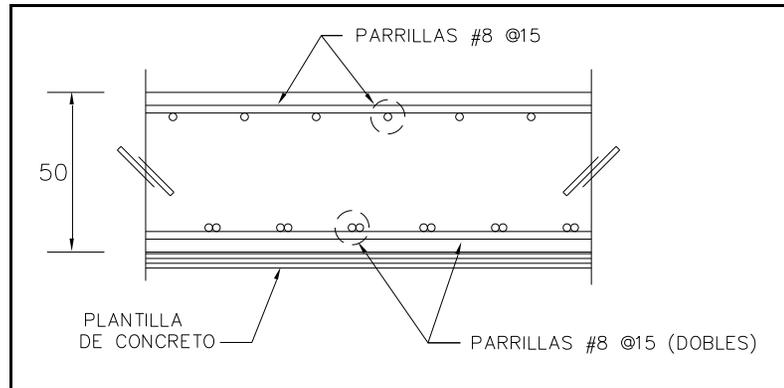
Detalle 3, losa inferior de candelero. Acotaciones en cm.
